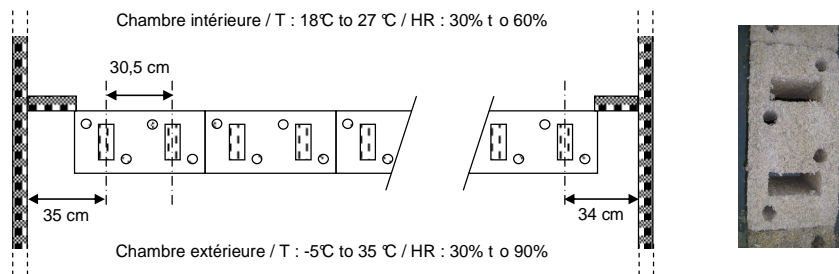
Coupe transversale du mur et photographie d'un bloc de béton de chanvre
